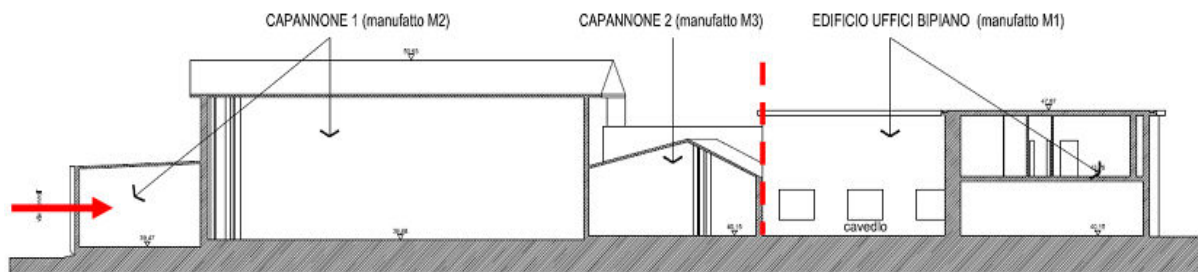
Sezione longitudinale cantiere in fase 1 (edifici M2 e M3)
